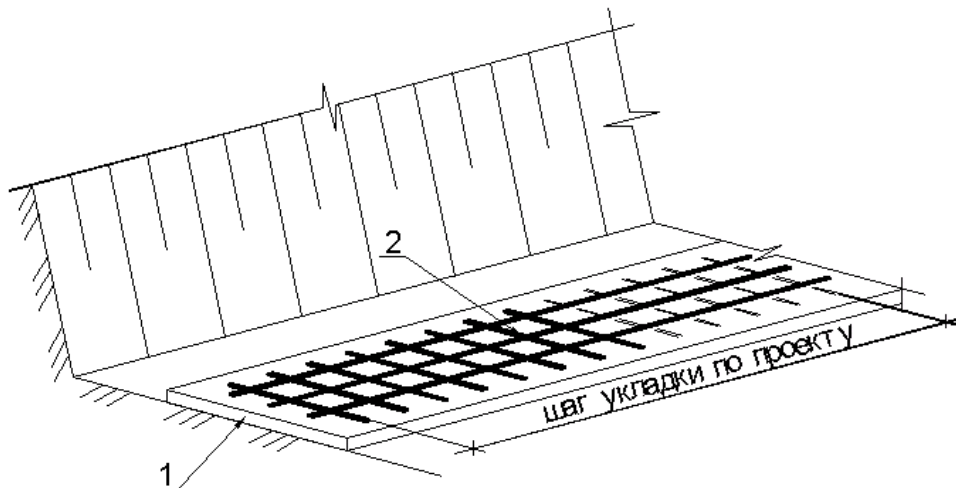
Укладка нижней сетки горизонтальных арматурных стержней.
